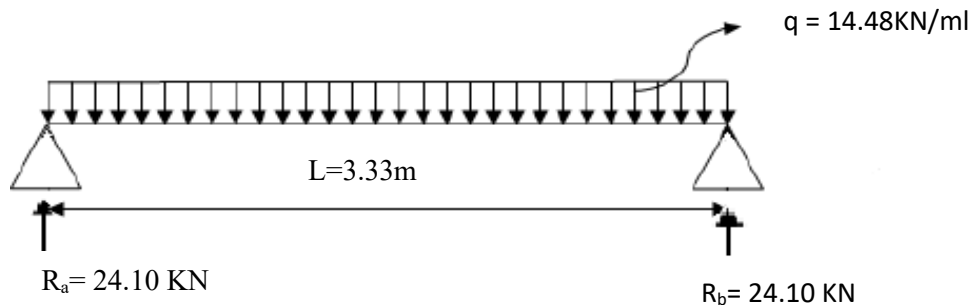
schéma statique de la poutre de chaînage à l'ELU
